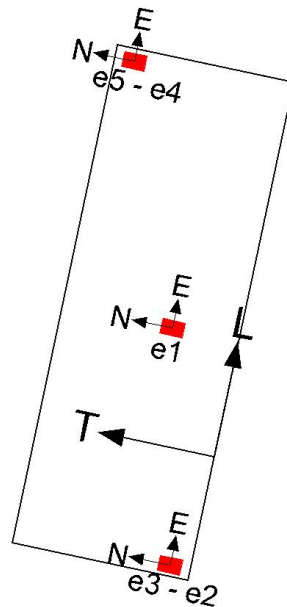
Vista en planta del edificio N°3. Ubicación, orientación y numeración de equipos utilizados
